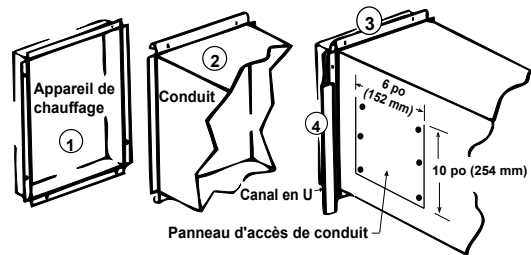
B – raccordement du conduit à l'appareil de chauffage
